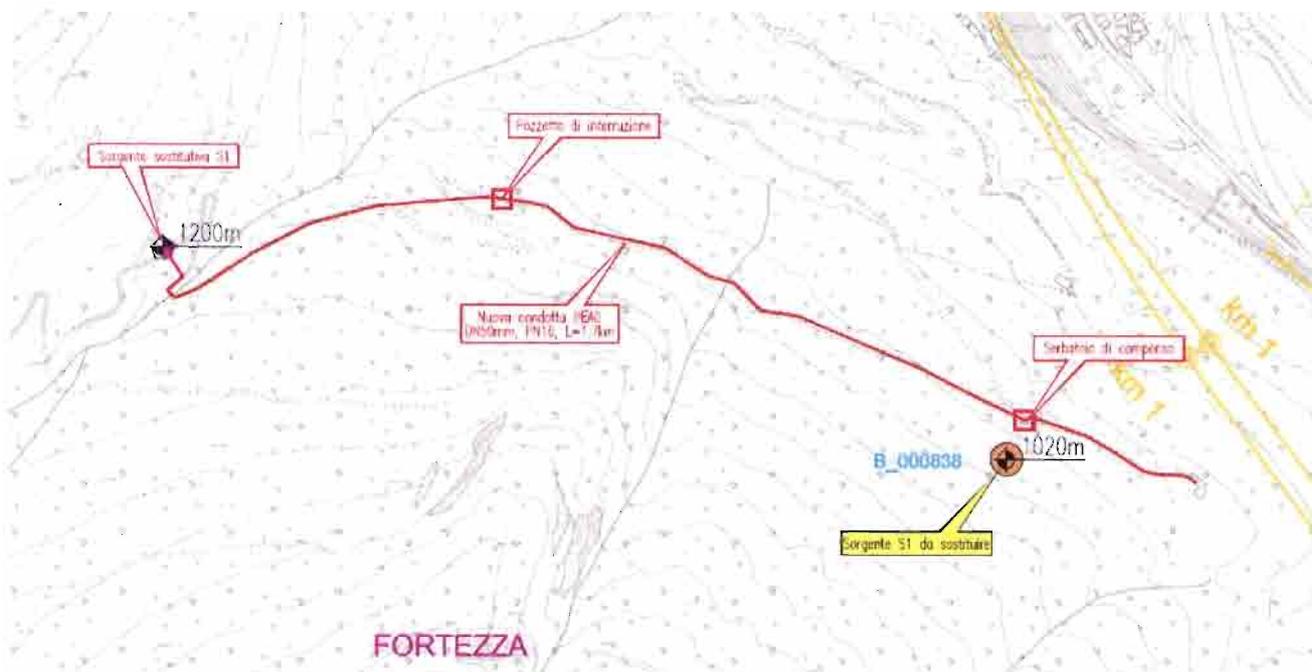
Stralcio planimetrico della soluzione progettuale selezionata.
